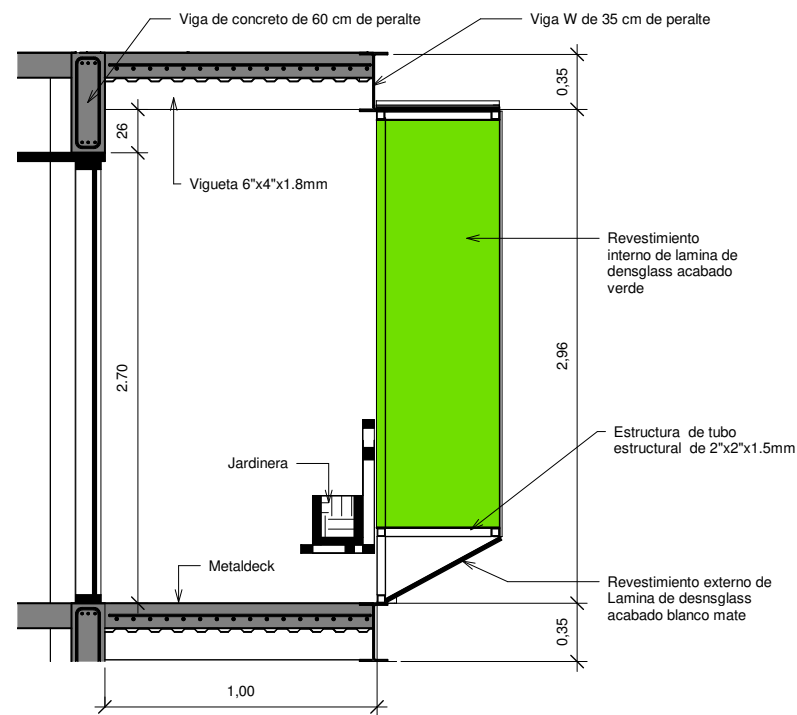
Detalle estructural en seccion ventanas periscopicas .
